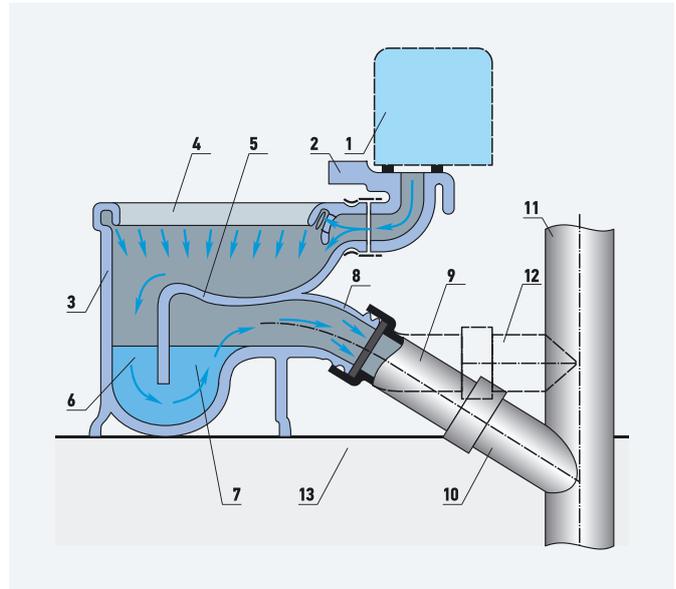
Схема тарельчатого унитаза с косым выпуском и бачком на полочке [1 — смывной бачок; 2 — приставная полочка; 3 — чаша смывного бачка; 4 — отбортовка; 5 — тарельчатая часть; 6 — приемный канал; 7 — гидравлический затвор; 8 — косой выпускной патрубок; 9 — фановая труба; 10 — возможный вариант ответвления канализационной трубы; 11 — канализационный стояк; 12 — основной отечественный вариант ответвления канализационной трубы; 13 — перекрытие]
